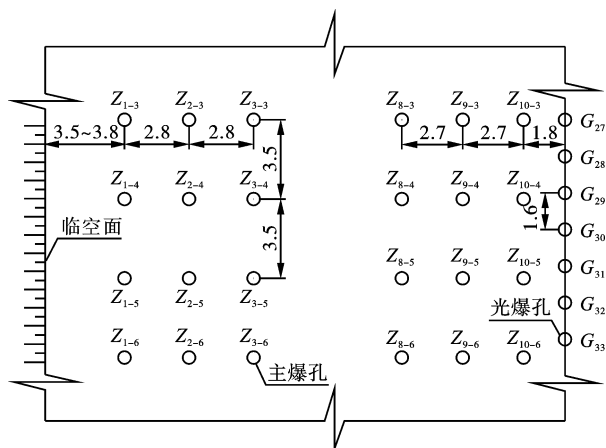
炮孔布置平面图(Z—主爆孔、G—光爆孔)(单位:m)
